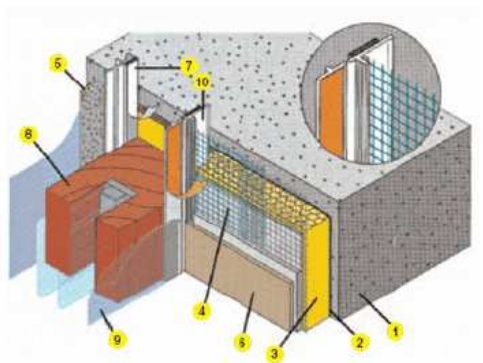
Detail aplikace výztužné síťoviny u fasádních otvorů
